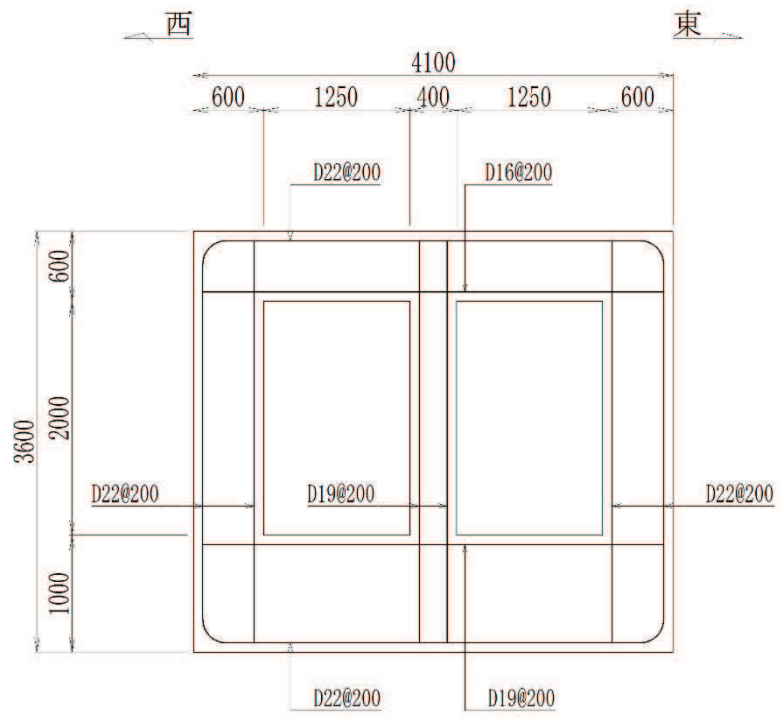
軽油タンク連絡ダクト概略配筋図 (A-A 断面)
